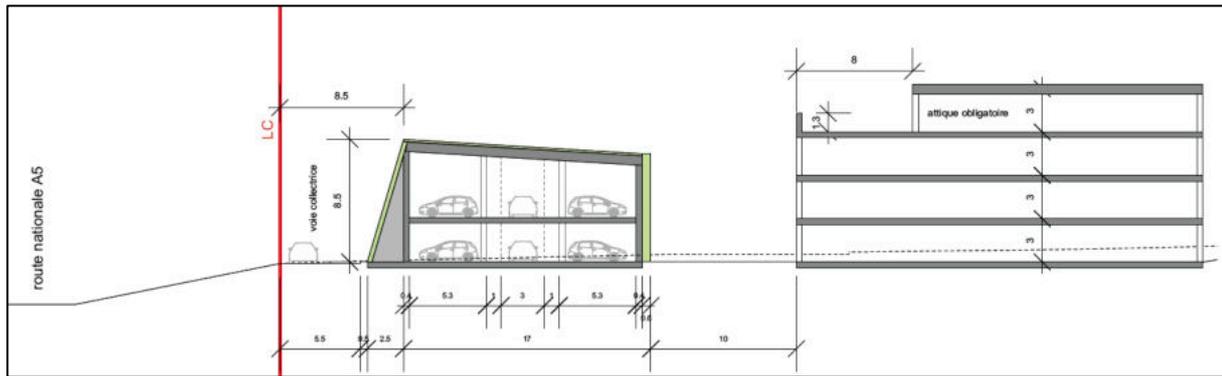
Coupe technique intégrée au règlement du PA – 2
